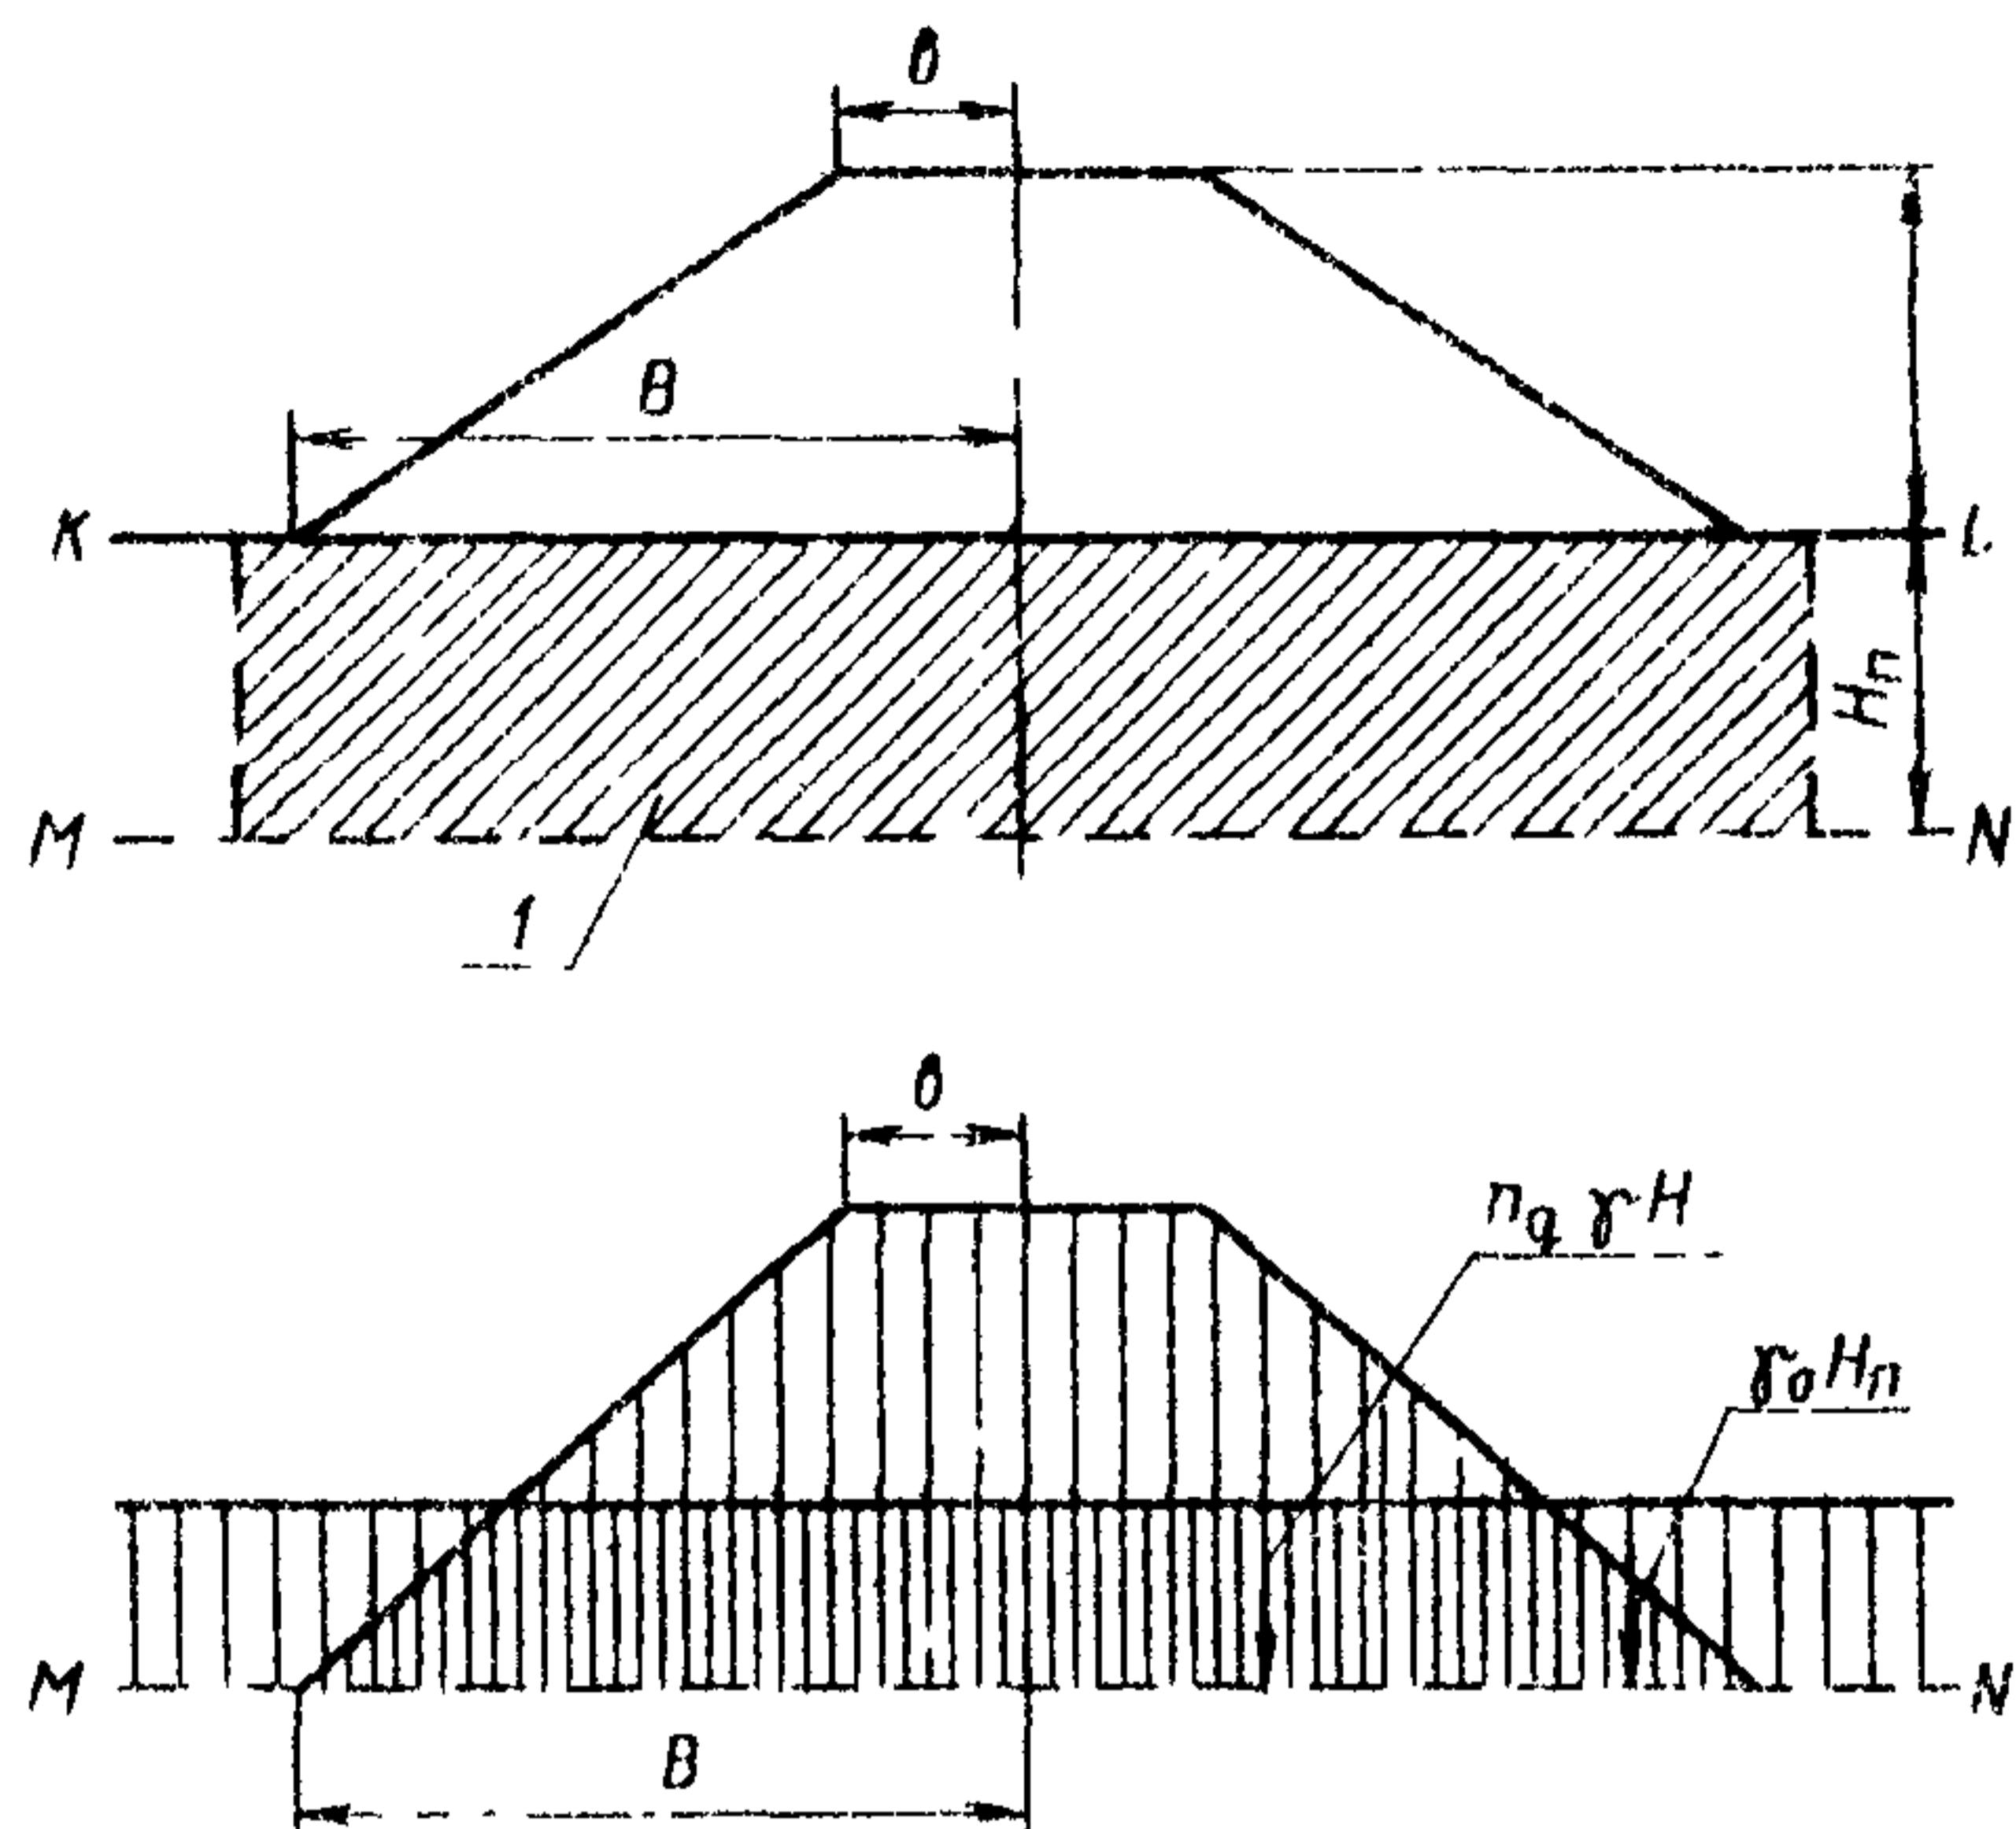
Схема нагрузок к расчету глубины замены грунта:
